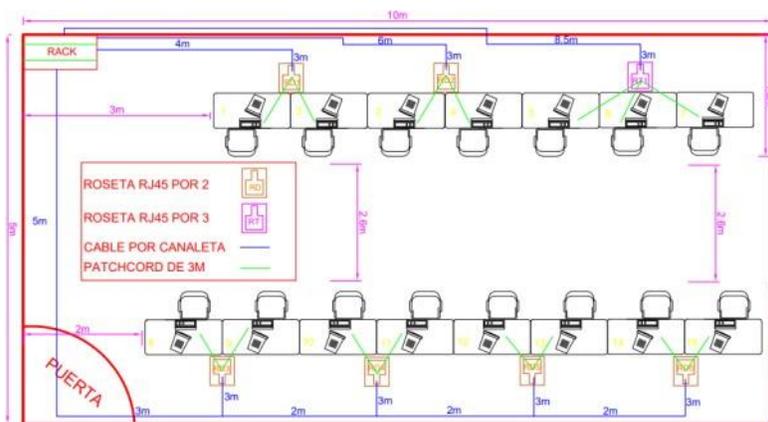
Plano estructurado de vista cenital para el centro "CENIT".
